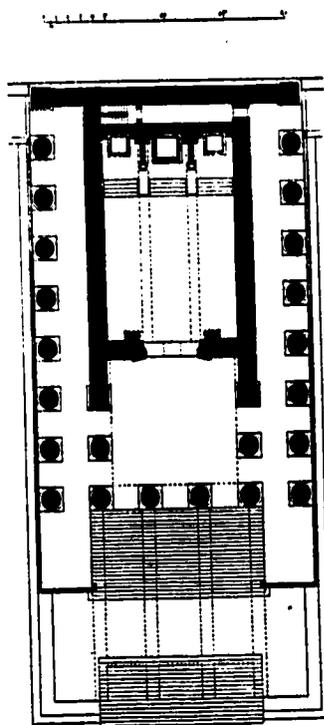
Plan restitué du Capitole par M. Bailly.
